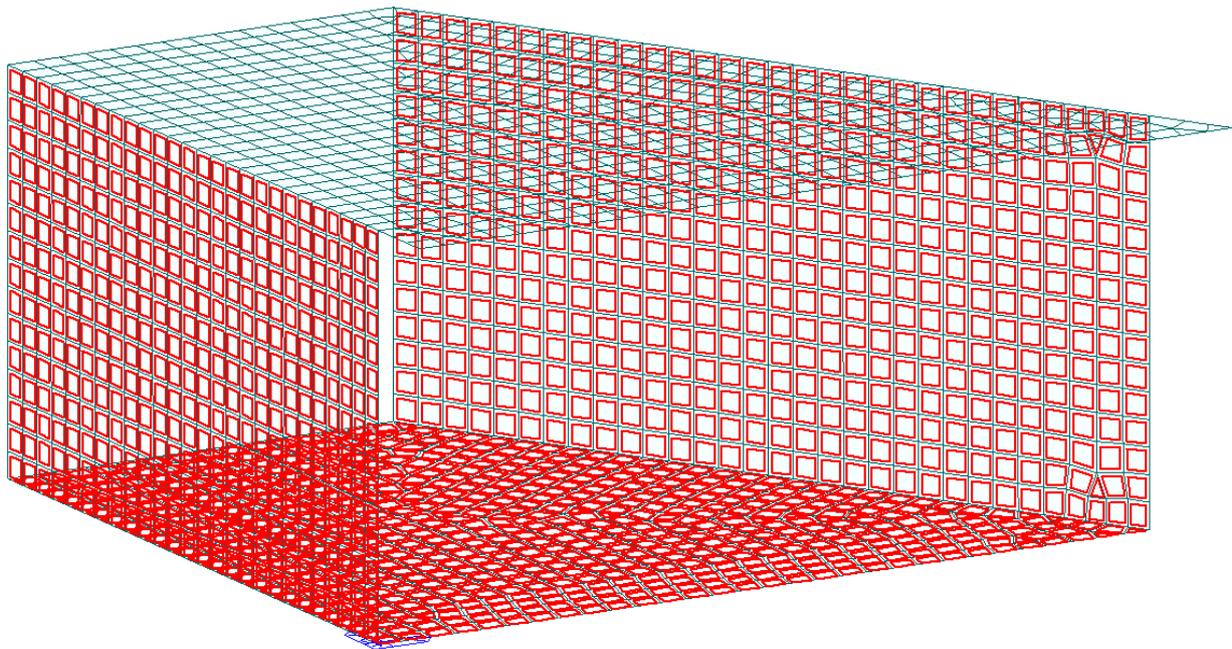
FEM 3D – Identificazione solaio di fondazione e pareti sp.60cm
